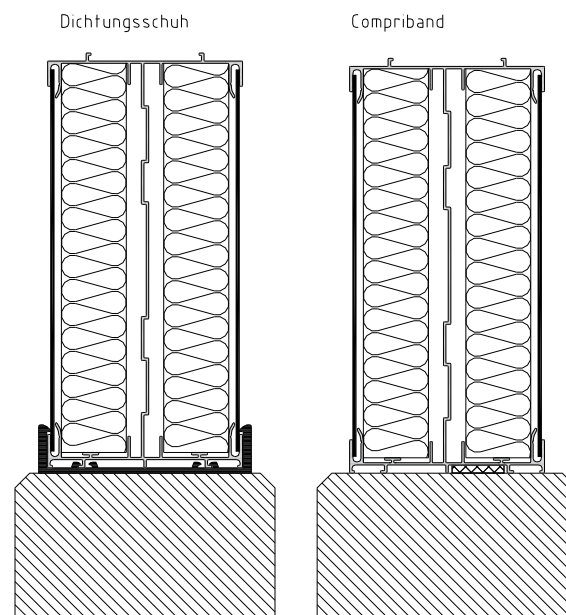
Auflagerung auf Sockelelementen aus Stahlbeton
